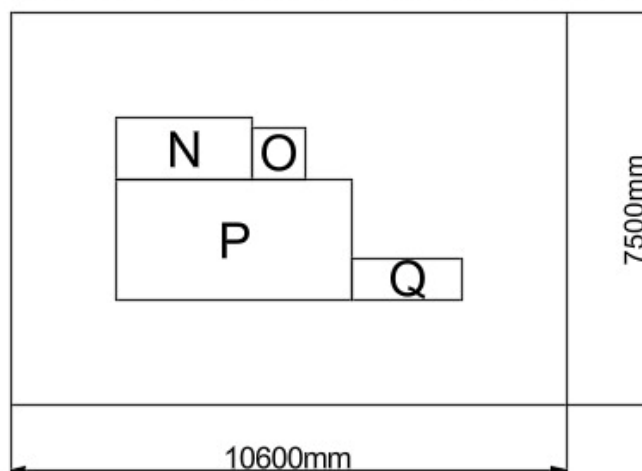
Figura XXIX. Lay Out de la planta tratamiento de efluente, en AutoCAD
